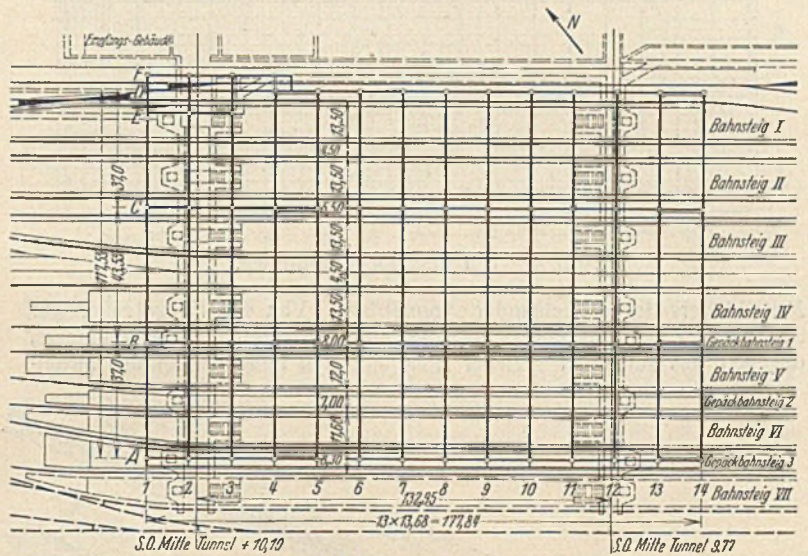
Lageplan zur Überdachung der Bahnsteiganlagen.
